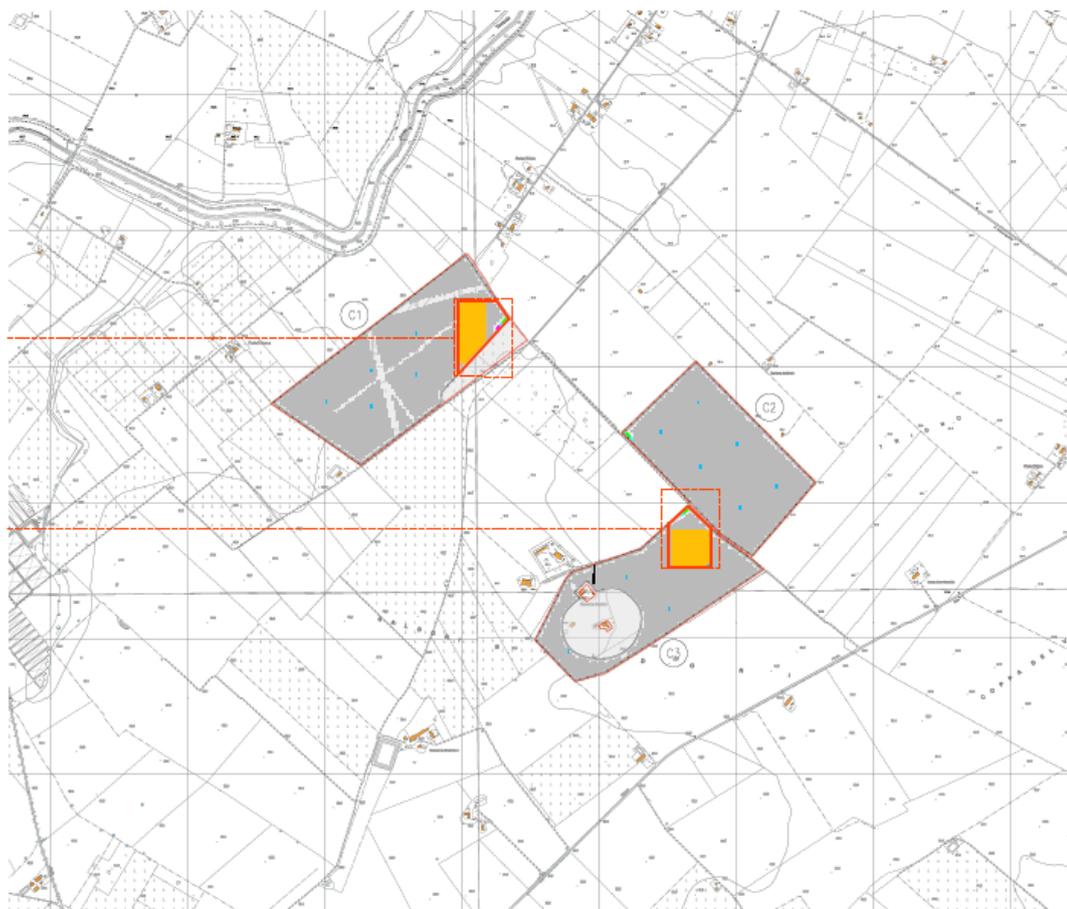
Aree di Cantiere previste all'interno dell'Area di Impianto
